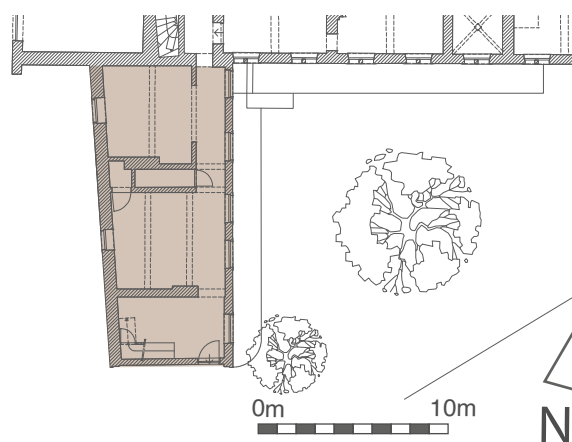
Plan du rez-de-chaussée de la zone L.08.
